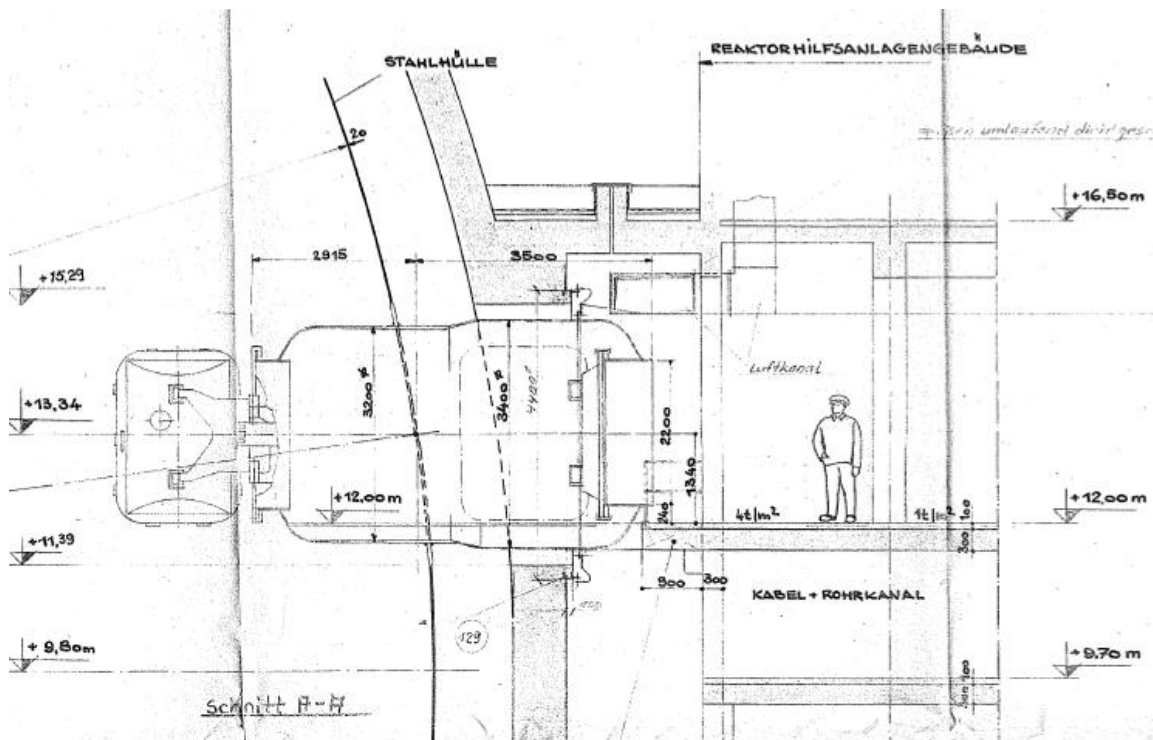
Esclusa de Personal – Vista en Planta – Nivel +12.00
